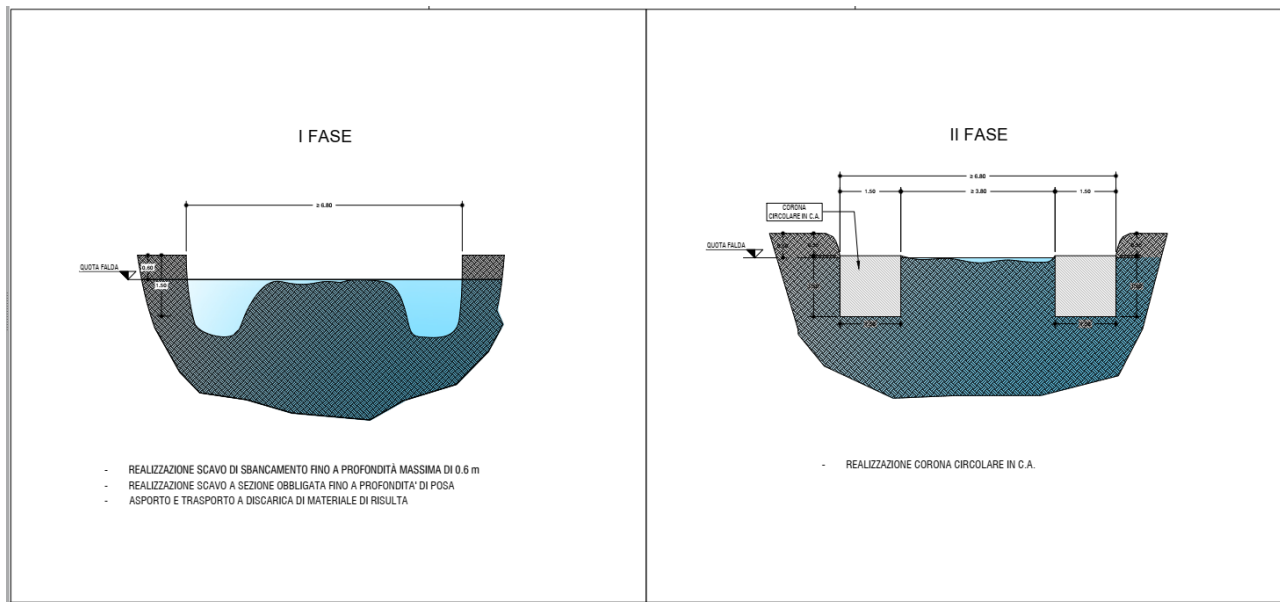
B : Schema tecnico realizzazione pozzo autoaffondante
